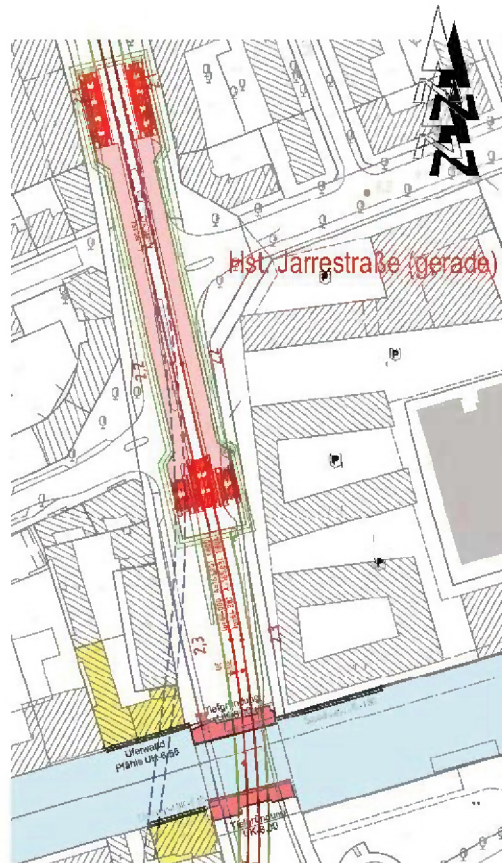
Haltestelle Jarrestraße I mit geradem Bahnsteig
